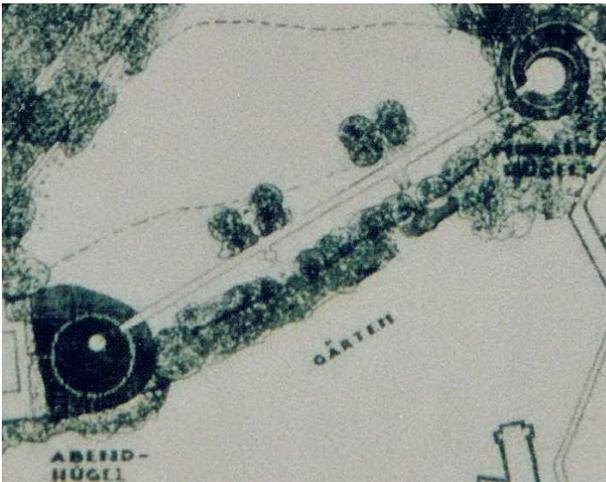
Lageplan aus WIEPKING 1932, (Ausschnitt)
